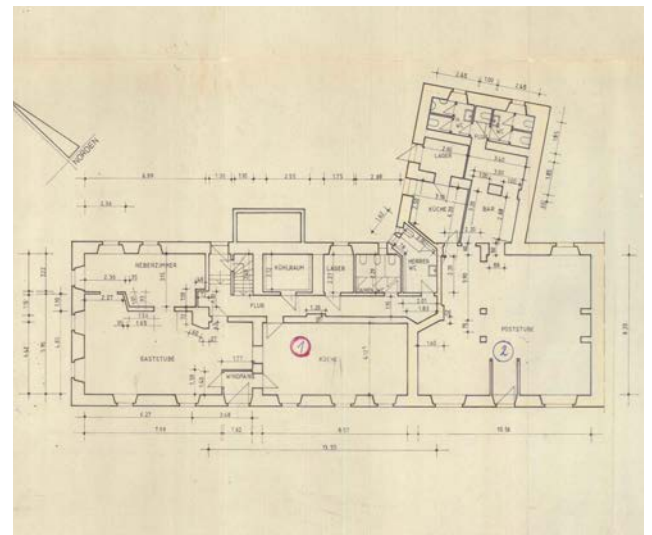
Erdgeschossgrundriss, Quelle: Bleyer Architekten (1984)
